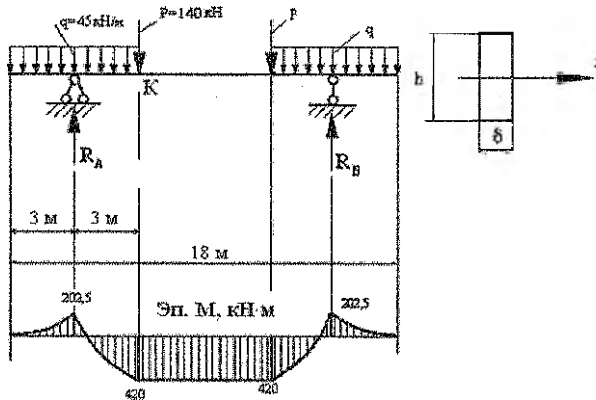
К расчету балки-стенки по балочной схеме (метод сопротивления материалов)
